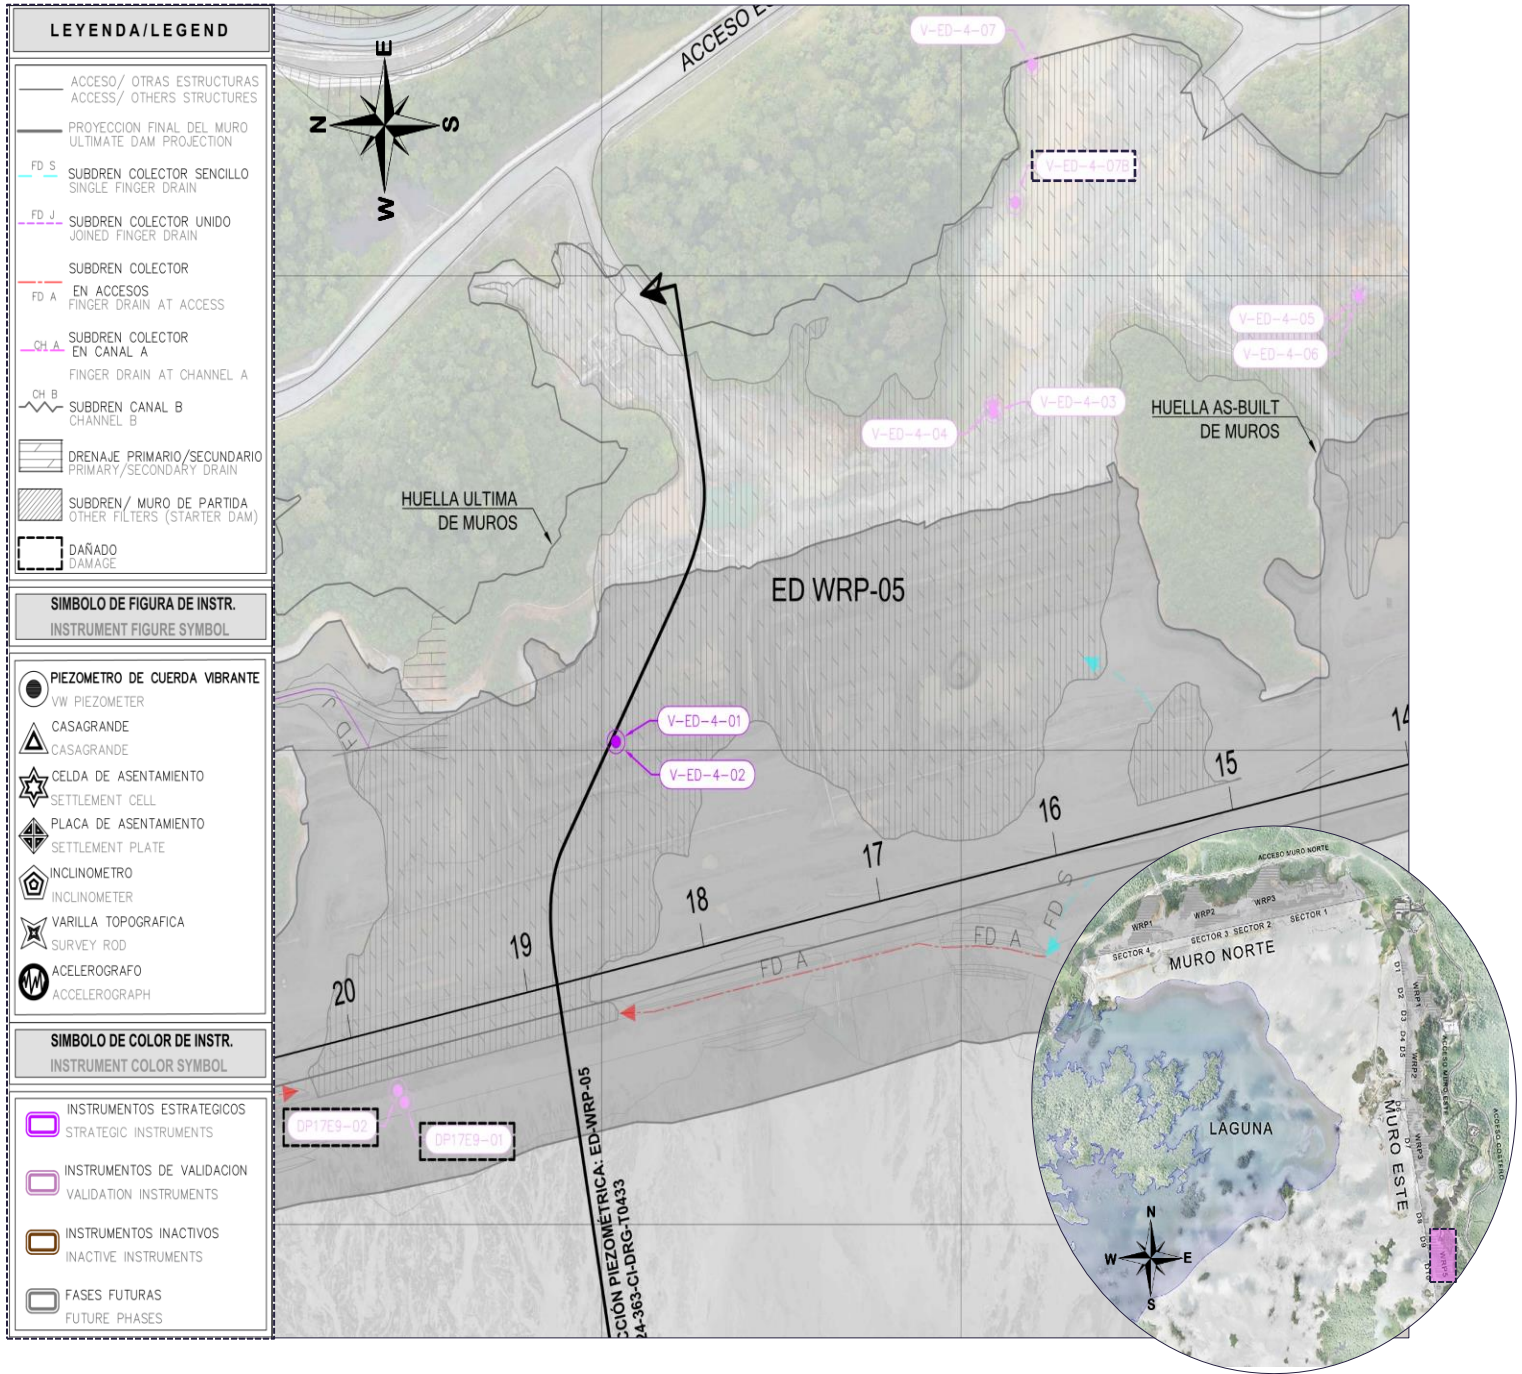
Vista de Planta en el Muro Este WRP5 con Piezómetros
